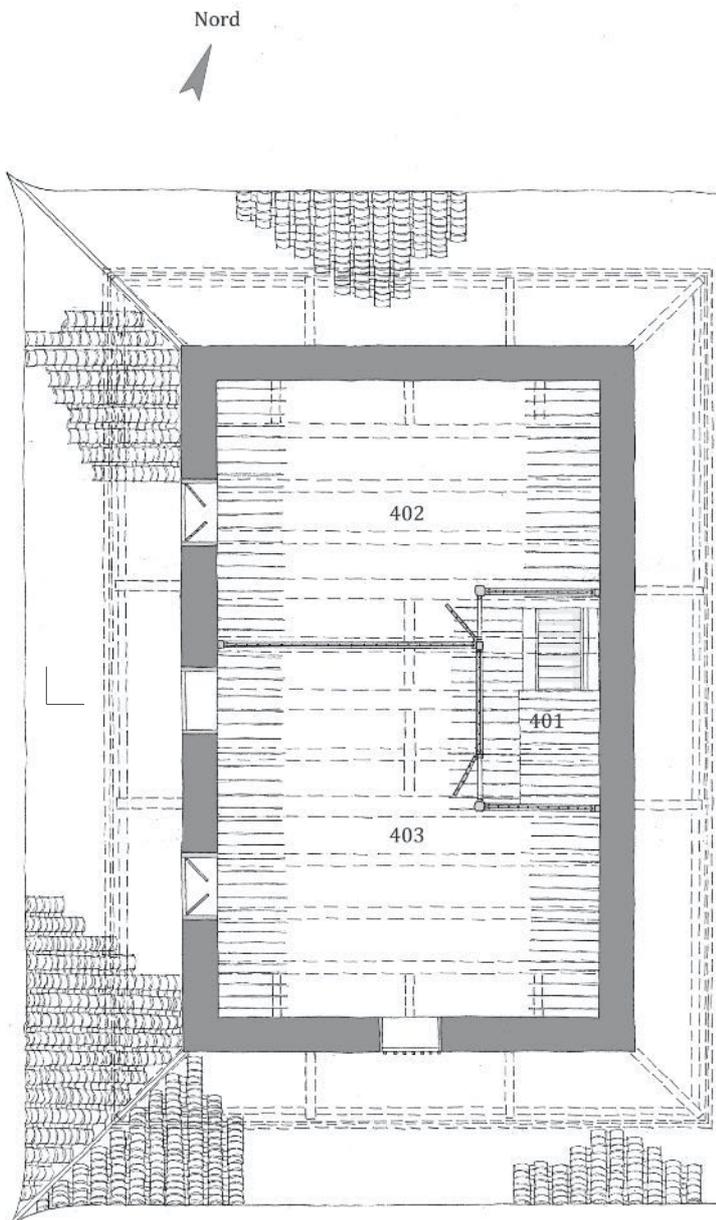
Grundriss Wachturm (4. OG), M 1:100
